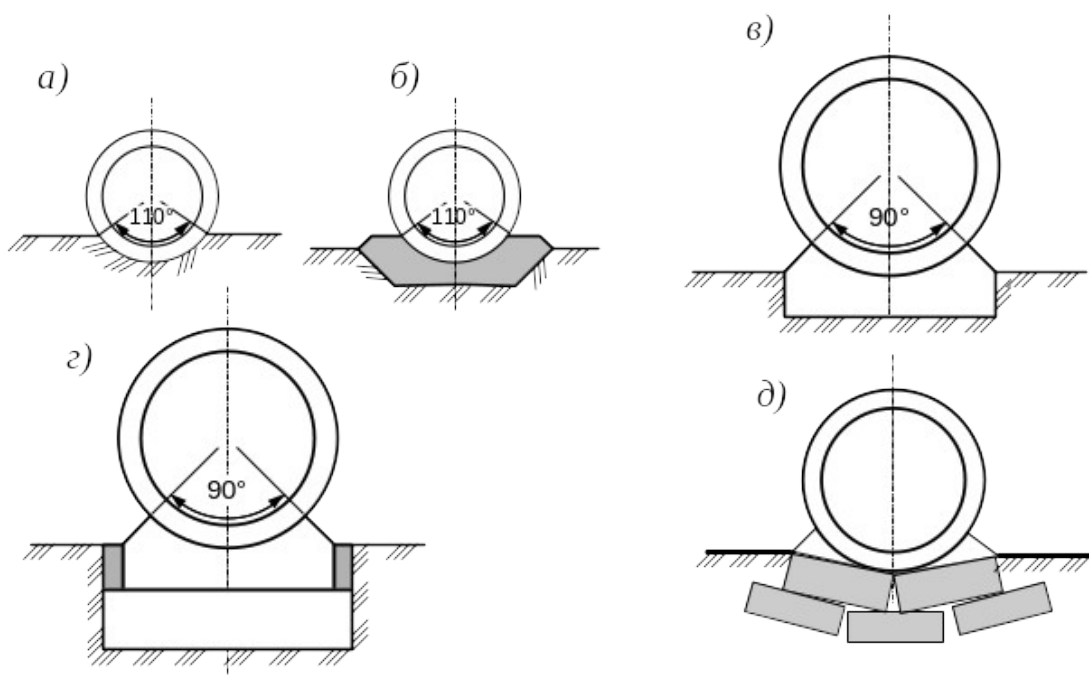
Способи укладання ланок труб круглого перерізу: а - без фундаменту; б - на гравійну підготовку; в - на лекальний блок; г - на збірно-монолітний фундамент; д - на фундамент з дрібних блоків (показана деформація фундаменту)
